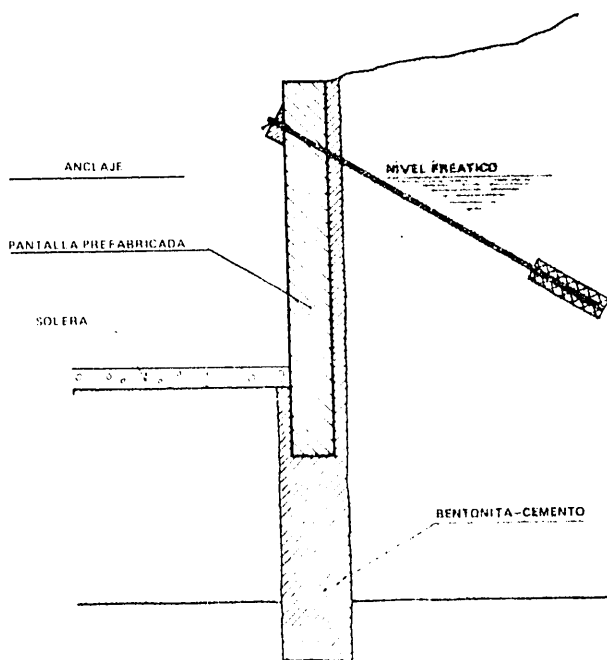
Pantalla mixta: prefabricada en la parte superior con misión resistente y blanda en la parte inferior, hasta alcanzar un estrato impermeable.
